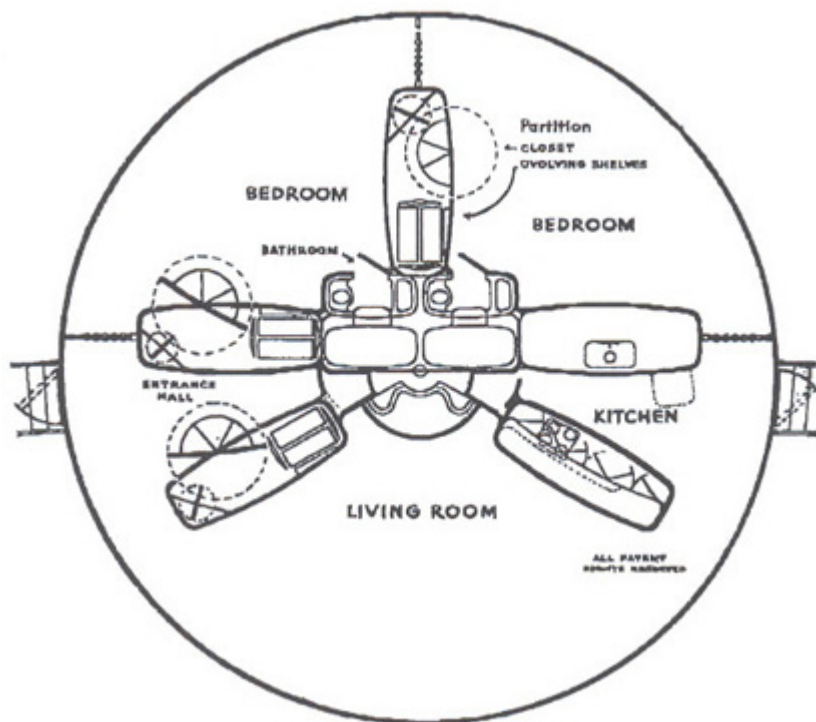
Planta (sem escala) da Dymaxion House de 1946.
